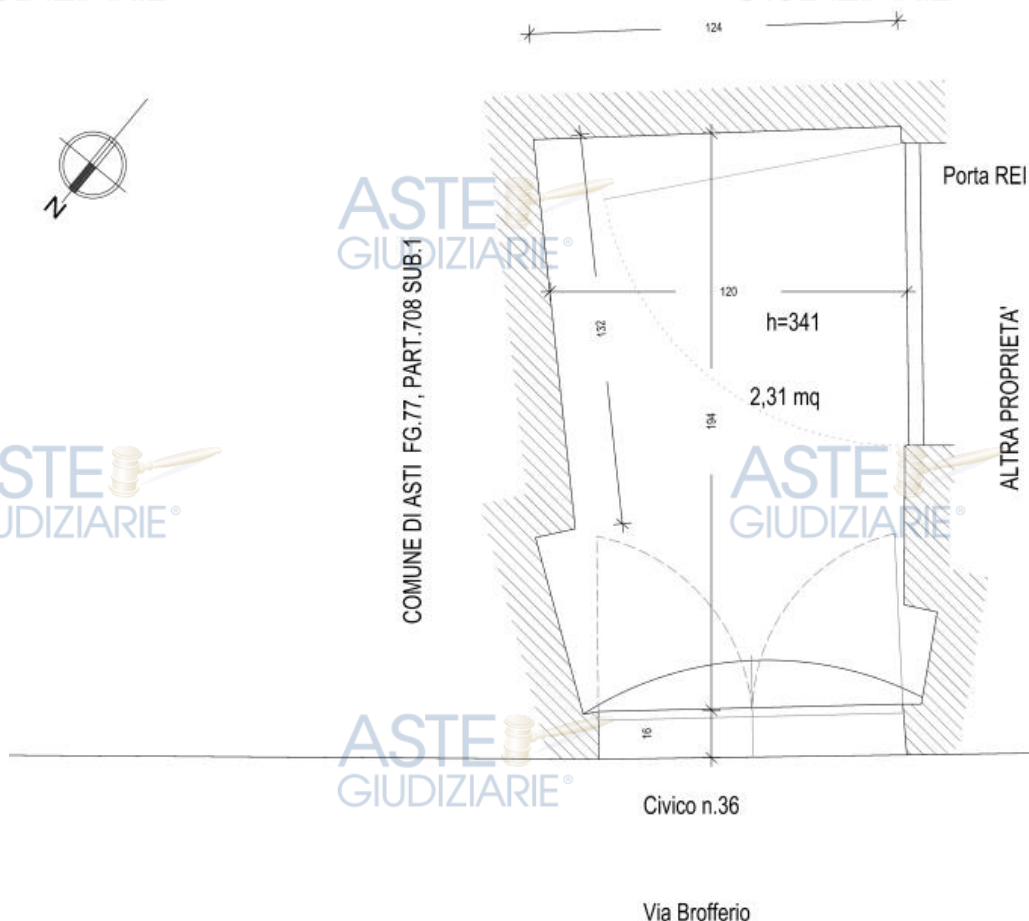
Estratto Allegato 4 – Tavola A- Planimetria disimpegno
